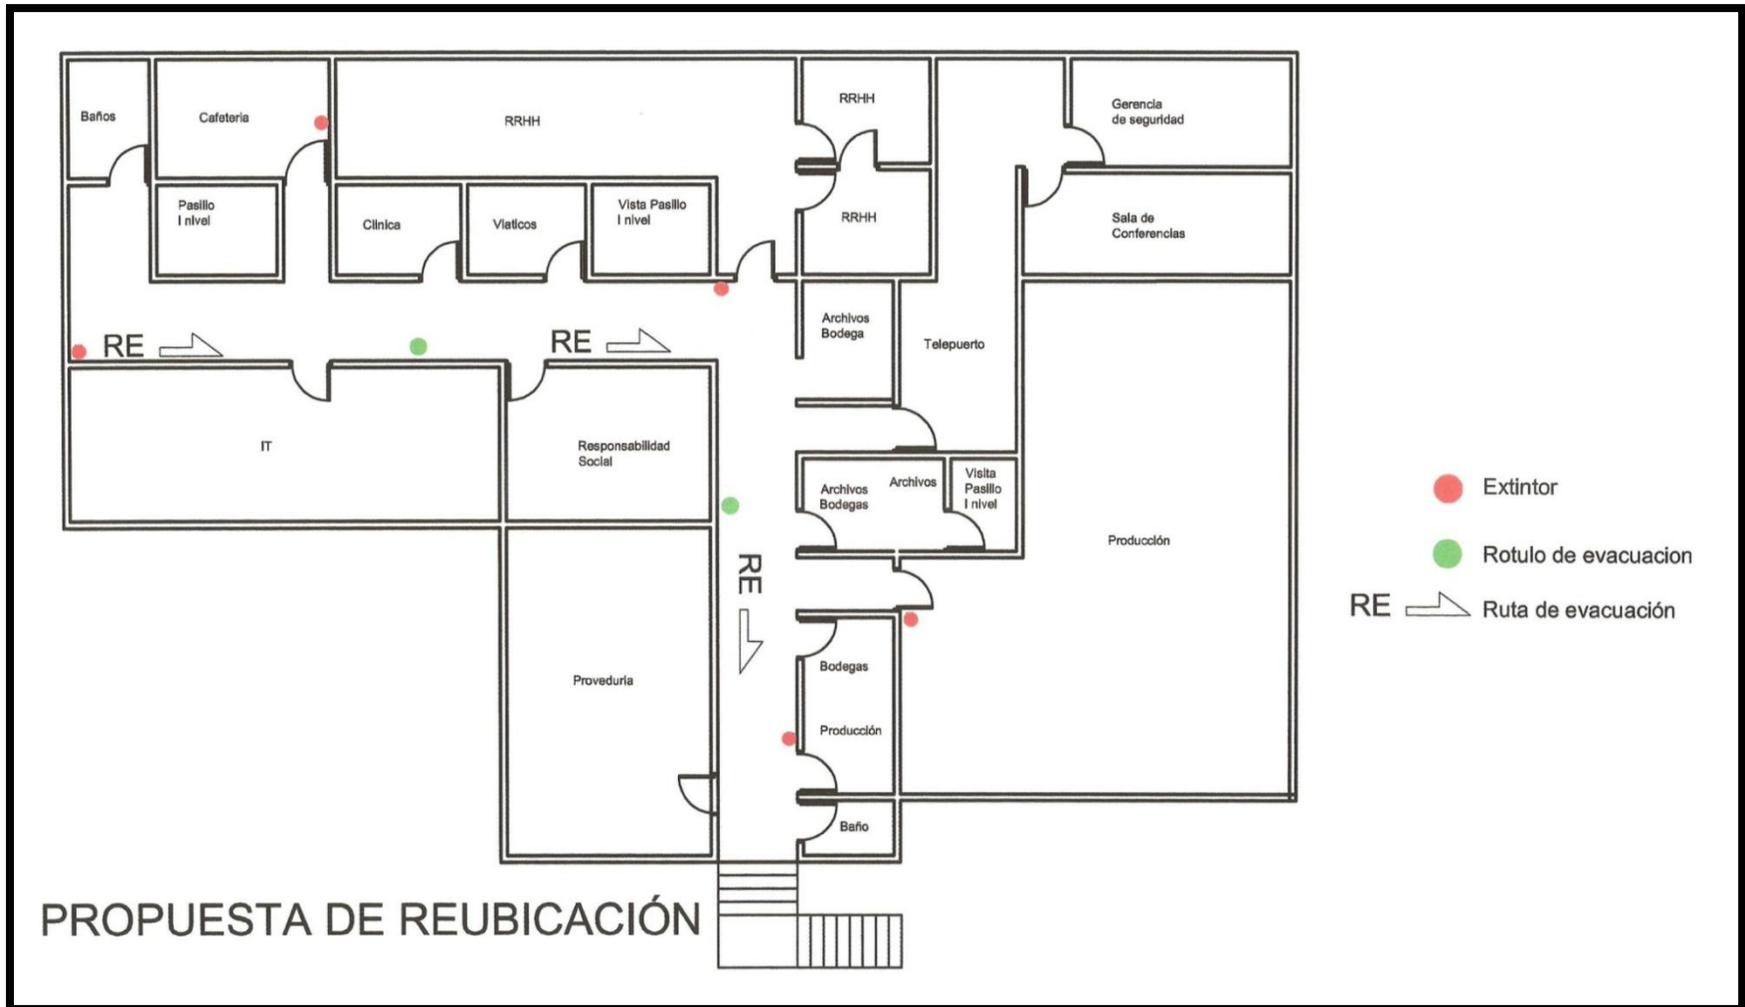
Vista Segunda Planta A.D. Propuesta de Reubicación
